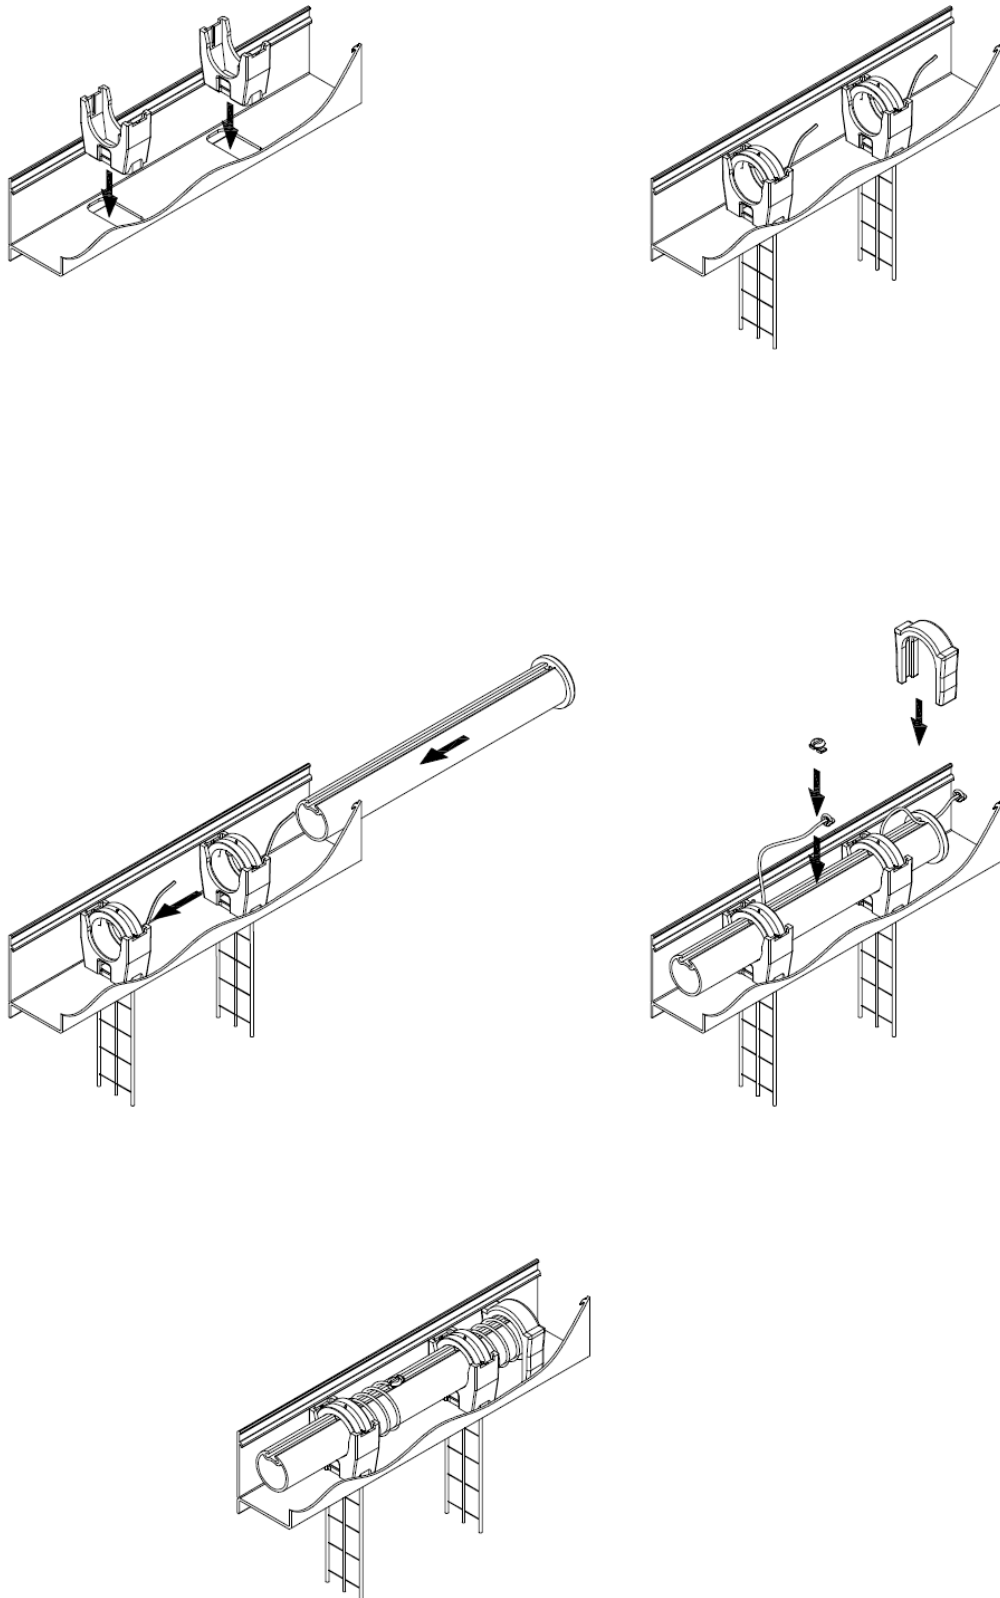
Supports tubes suspendes et échelles au niveau du caisson haut
